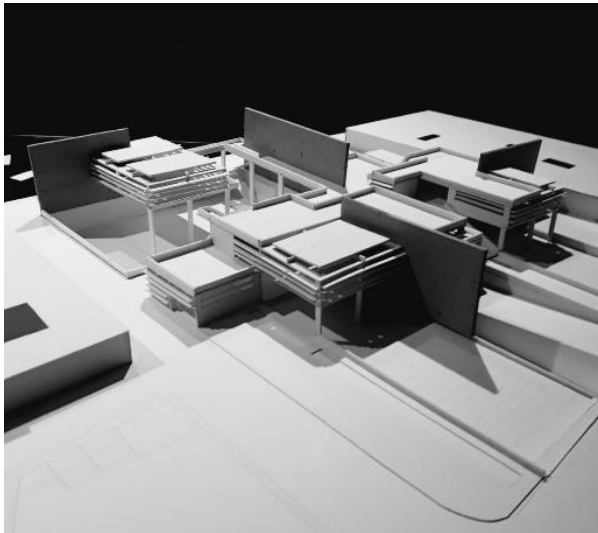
Maqueta, proyecto arquitectónico 2 (Sanchez J. , Fotografía , 2018)
